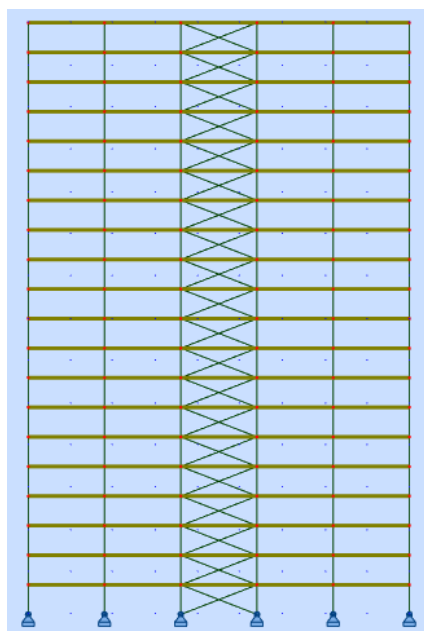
Contraventamento paralelo à maior dimensão em planta baixa
